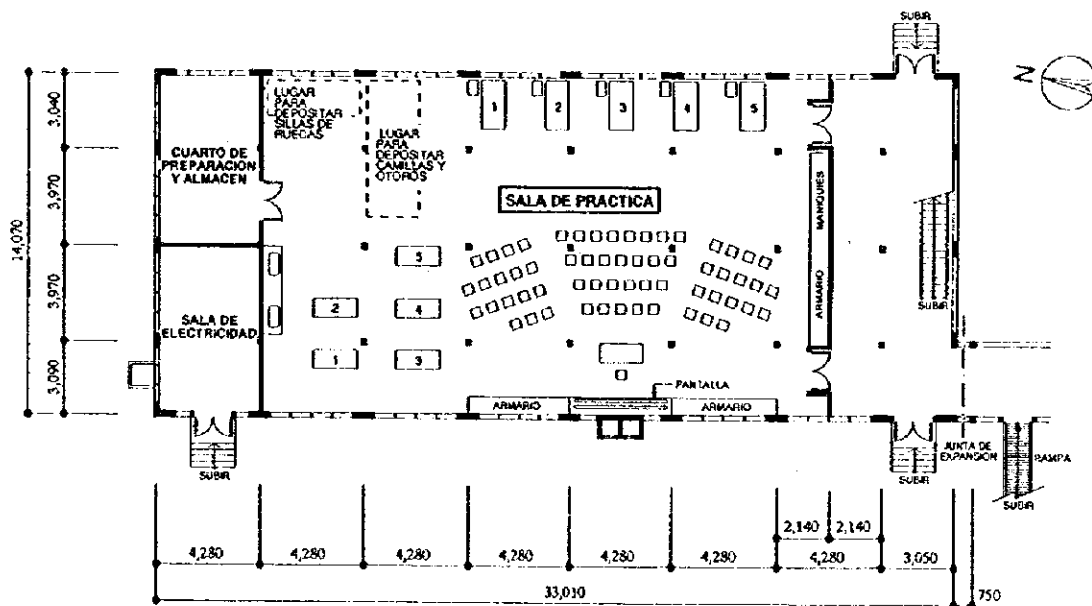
Plano del plan de sala de práctica por la remodelación
